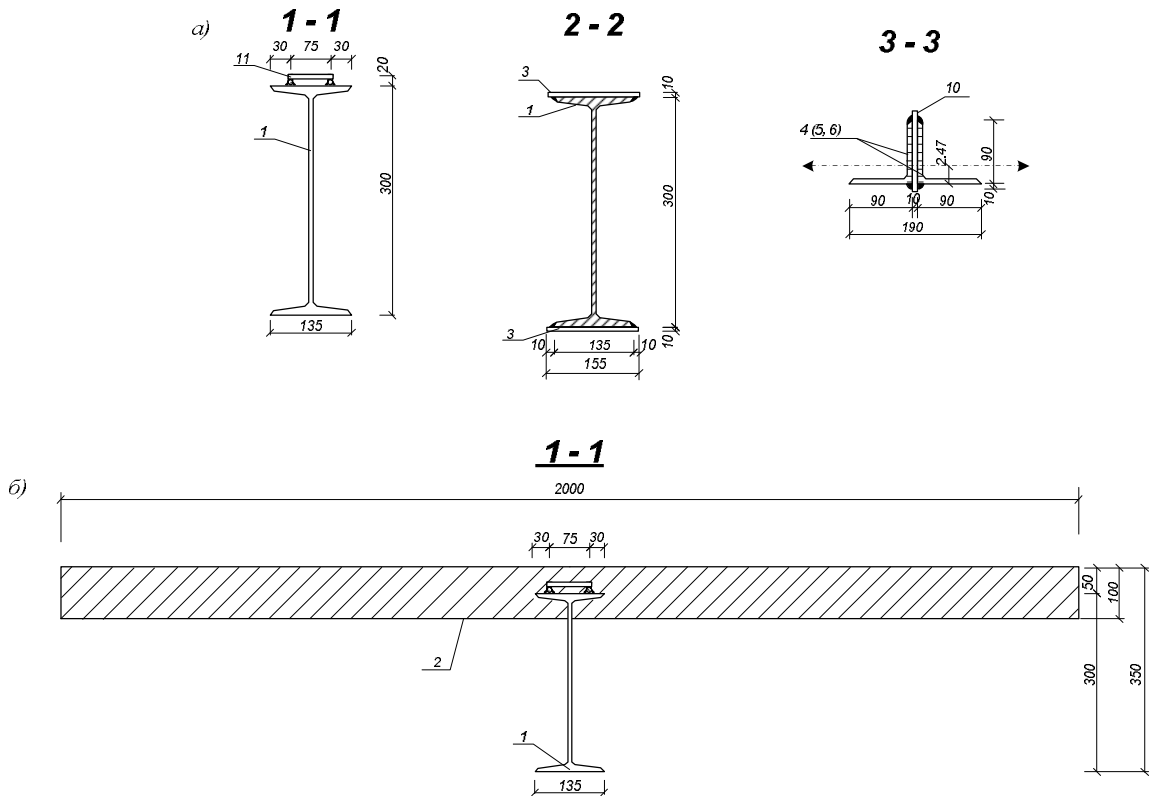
Перетини комбінованої конструкції: а – до бетонування; б – після бетонування
